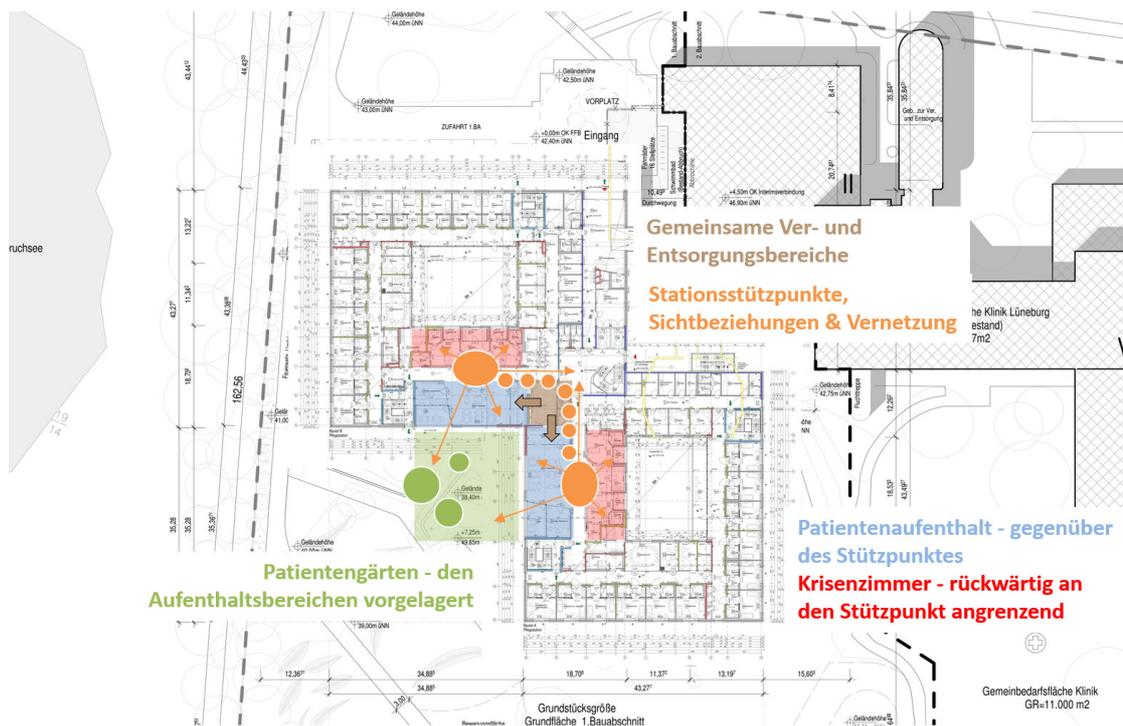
\_ geplante Grundrissstruktur mit funktionalen Vorgaben
